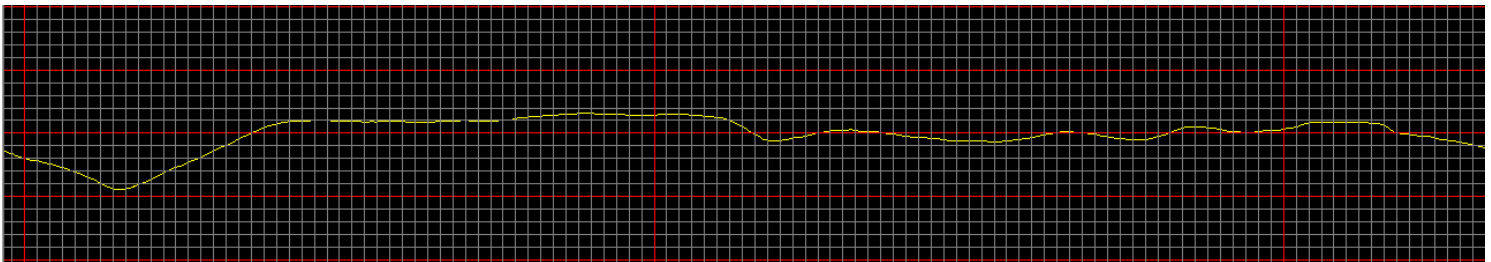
Vista del perfil del proyecto geométrico de carretera con su respectiva retícula (AutoCAD 2010).
